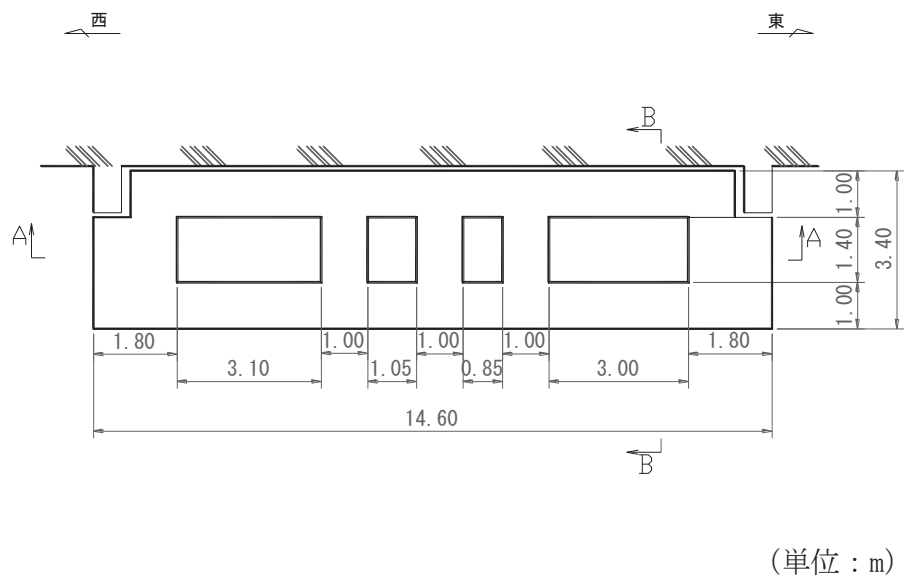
第 3 号機補機冷却海水系放水ピット平面図 (D-D 断面)
